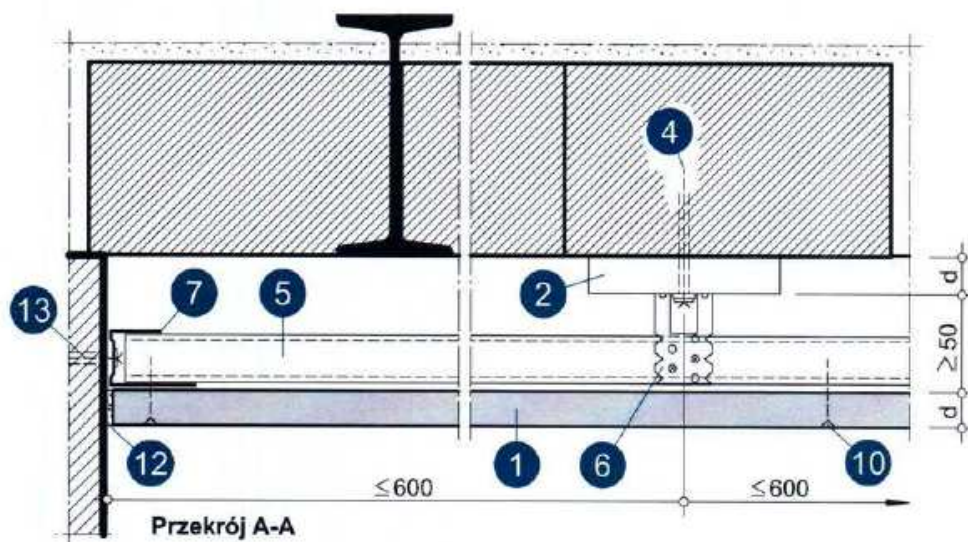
Przekrój A-A, strop z pustaków ceramicznych, betonowych lub z betonu lekkiego
